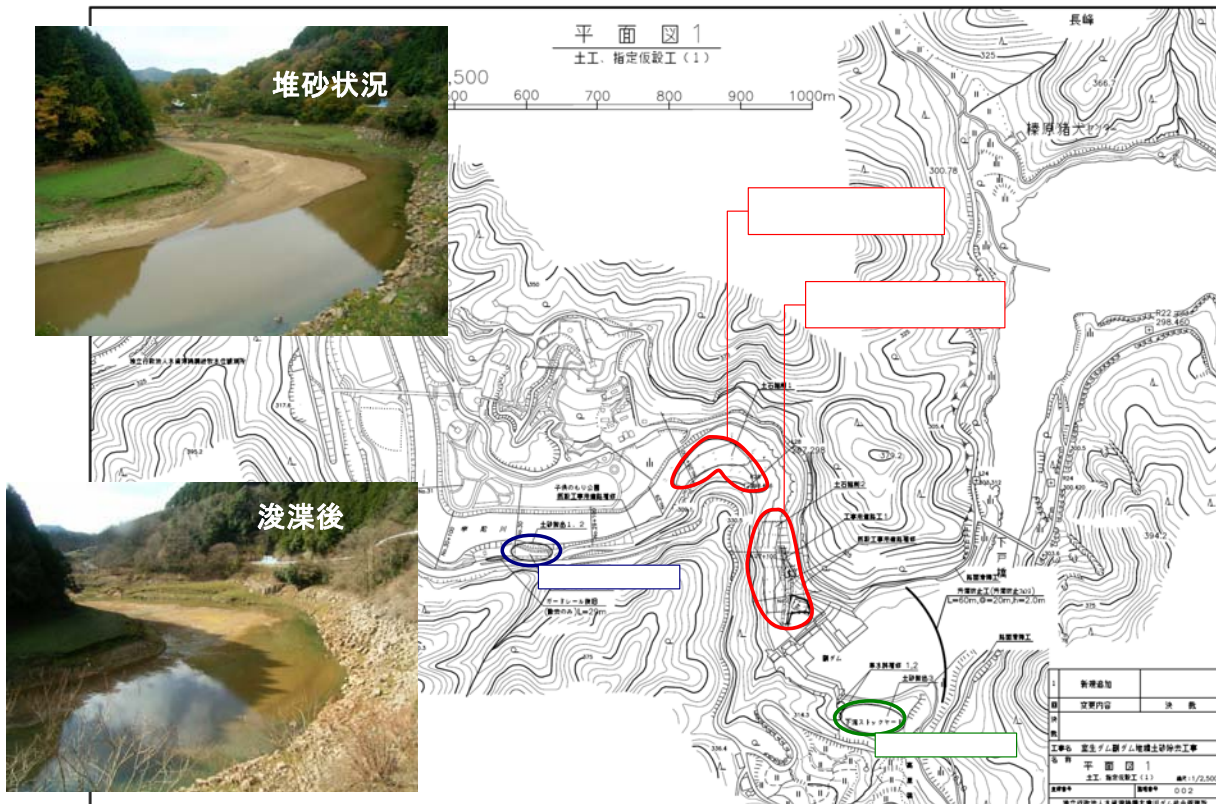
2008(平成 20)年度浚渫工事箇所平面図
